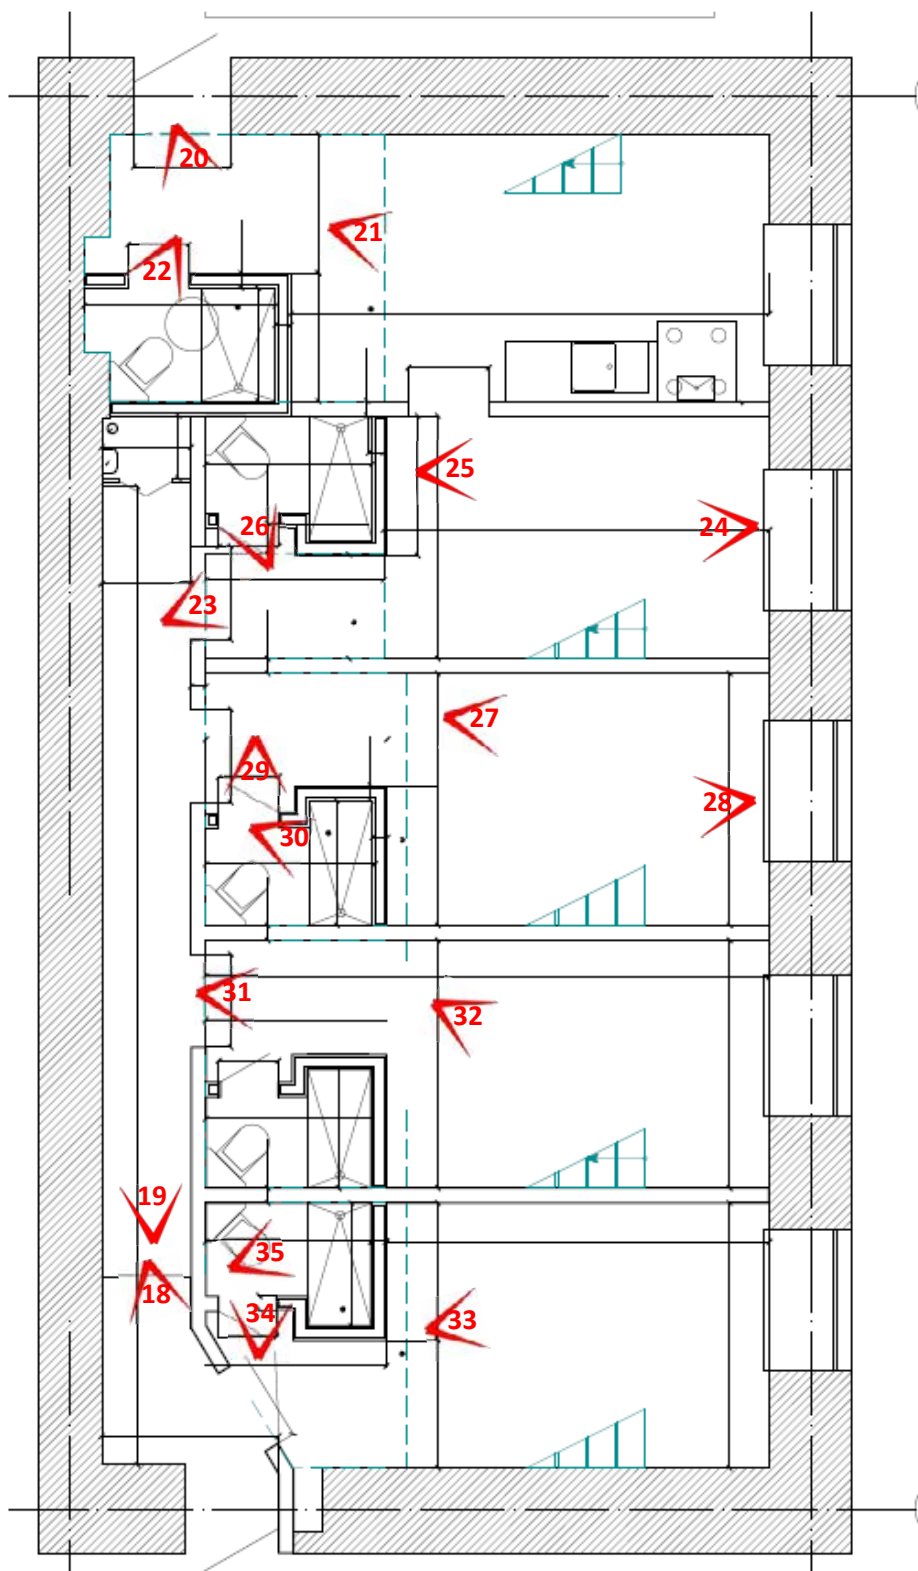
Схема фотофиксации на фрагменте плана 1 этажа
